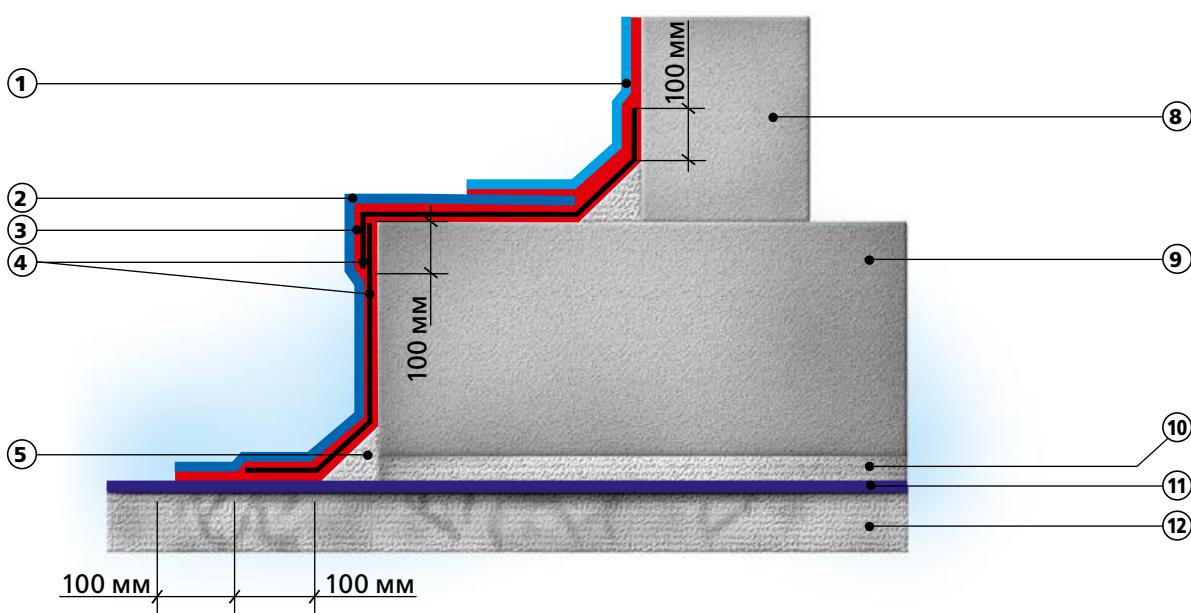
Зона подошвы фундамента. Вариант со сплошным слоем усиления:
